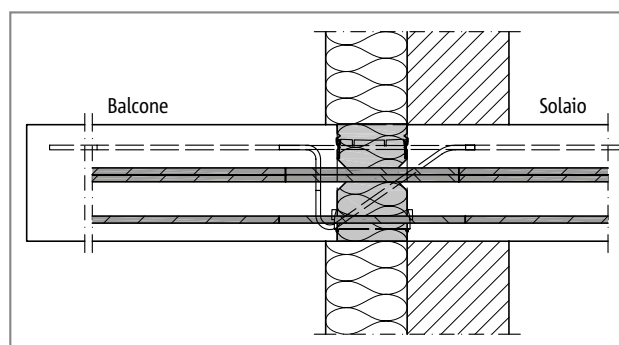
Schöck Isokorb® tipo KXT, EQXT: sistema isolamento a cappotto (WDVS)
